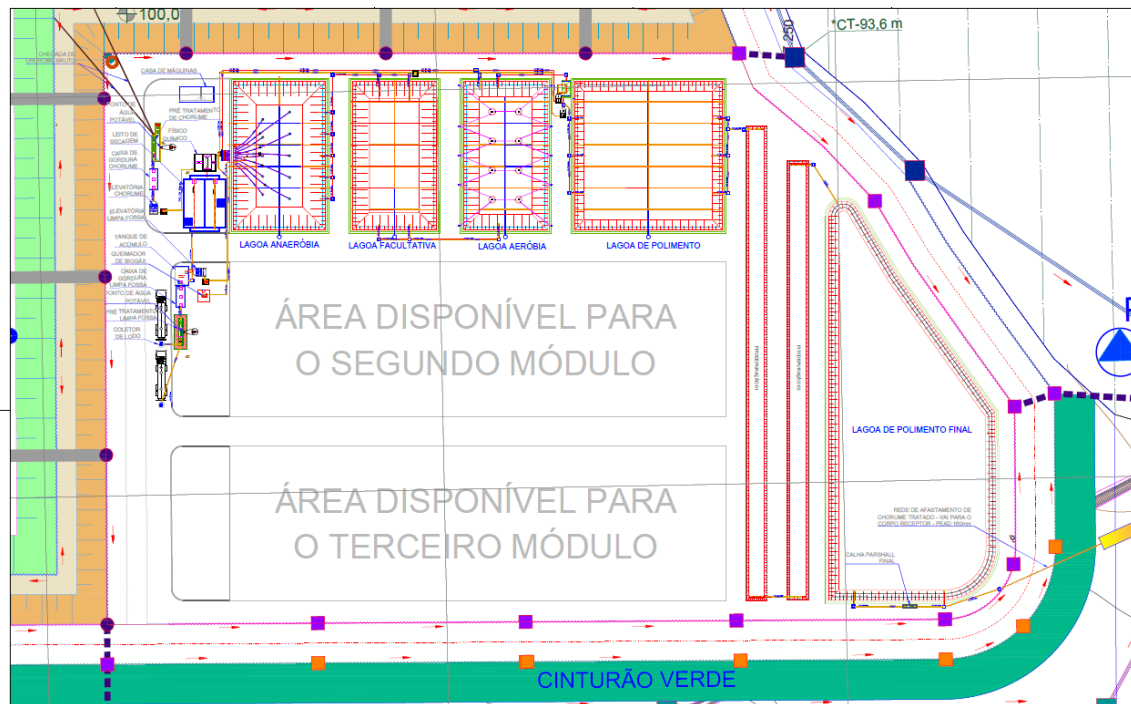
Planta de localização da primeira fase de implantação da ETE – Primeiro módulo.
